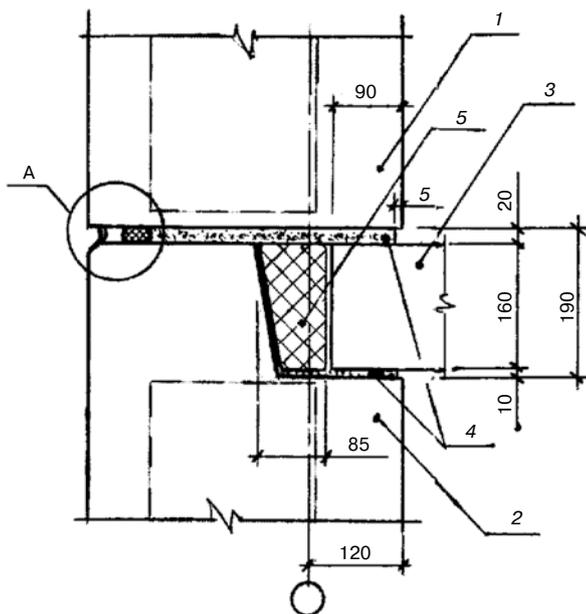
Стык между наружными панелями: 1, 2 – верхняя и нижняя стеновые панели; 3 – плита перекрытия; 4 – растворные швы; 5 – вкладыши из минераловатной плиты П-125 ГОСТ 9573–96, обернутый пергамином
